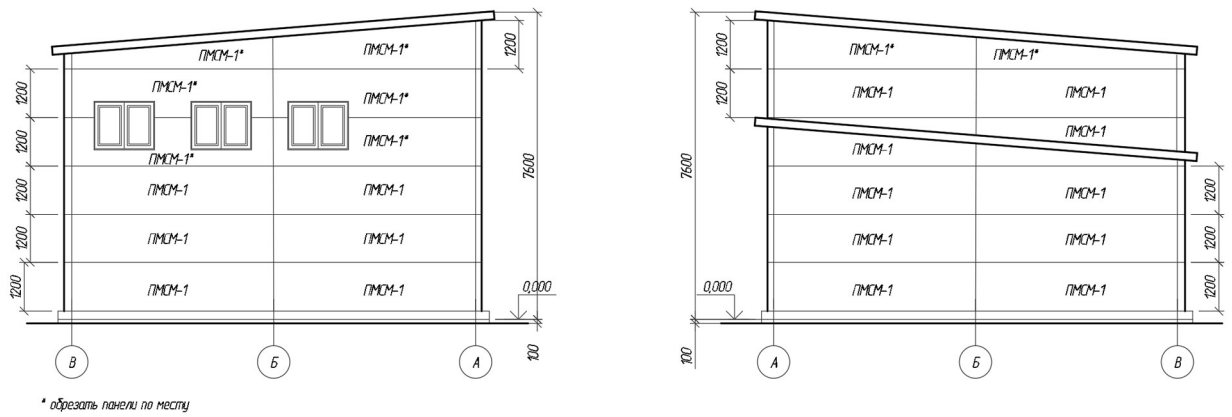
Схема раскладки сэндвич-панелей по фасадам В-А/А-В
